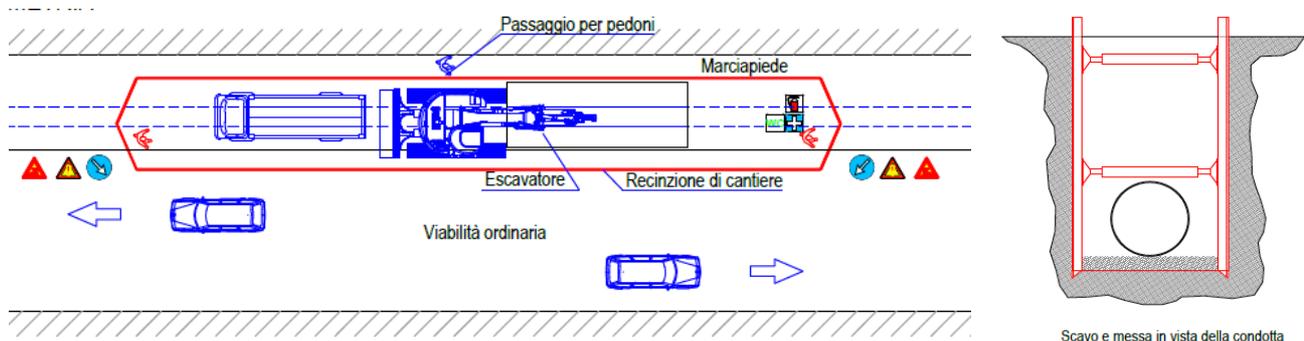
Planimetria e sezione tipo dell'intervento di sostituzione.
